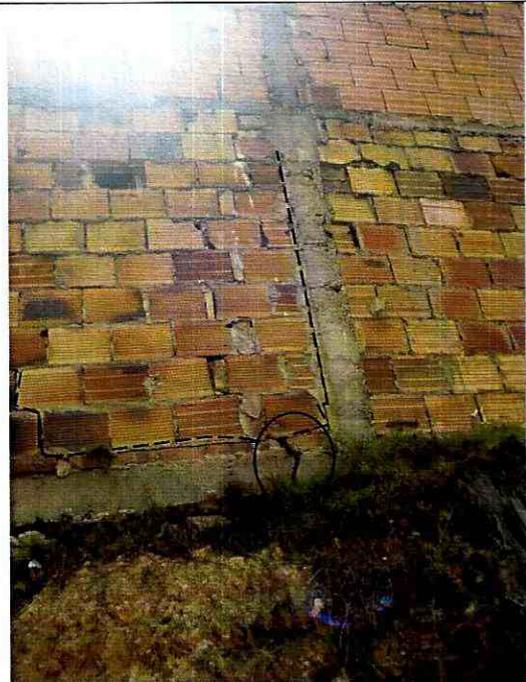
Falla de la viga de amarre localizada en la parte posterior de la edificación y presencia de grietas.
